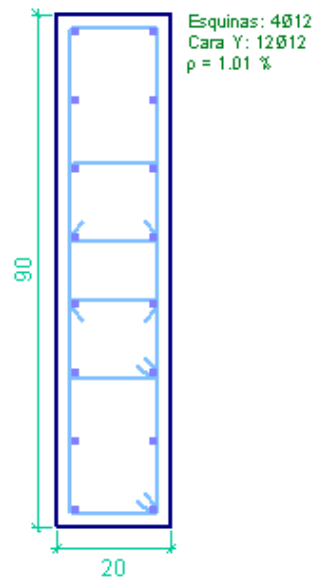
Detalle de armado de columna CF1 para planta baja.
